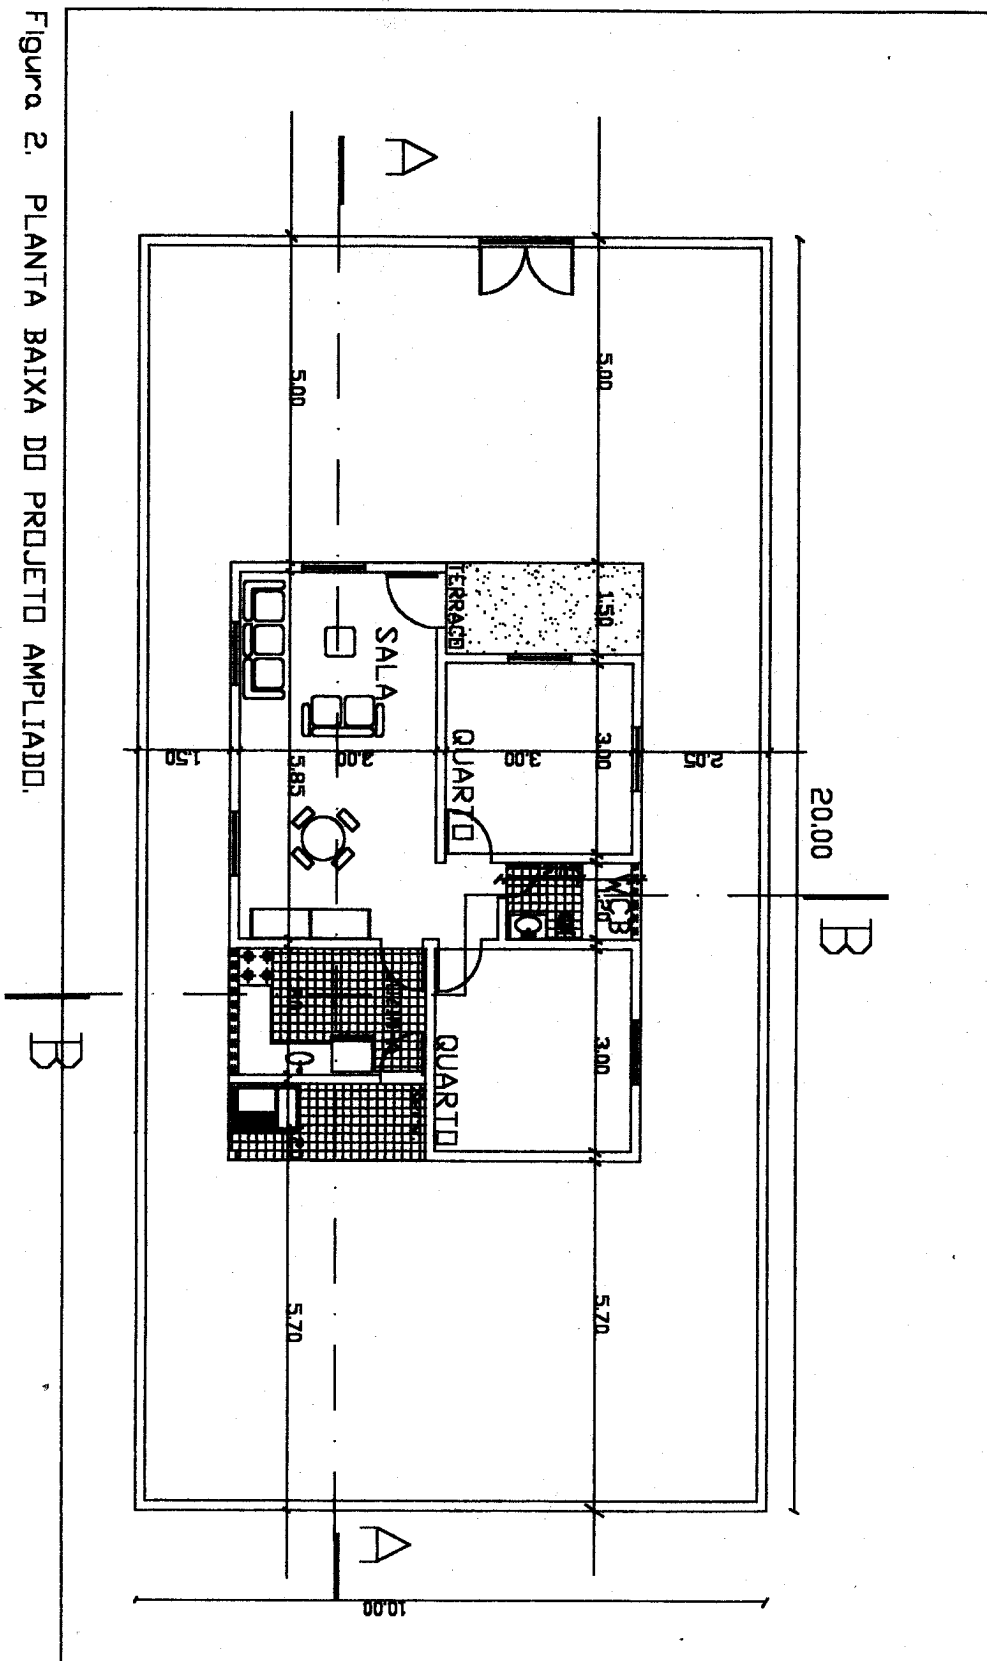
PLANTA BAIXA DO PROJETO AMPLIADO.
